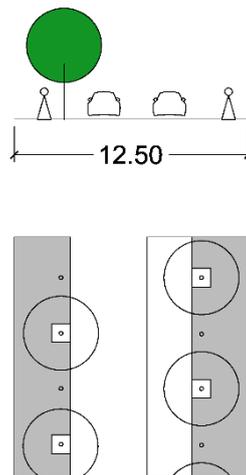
Propuesta de Sección Tipo I. Fuente. Elaboración propia.
